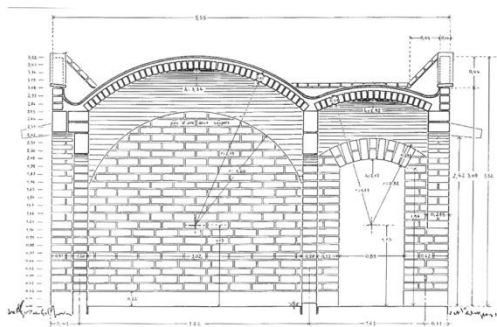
Sección constructiva y vista exterior desde la cubierta.
